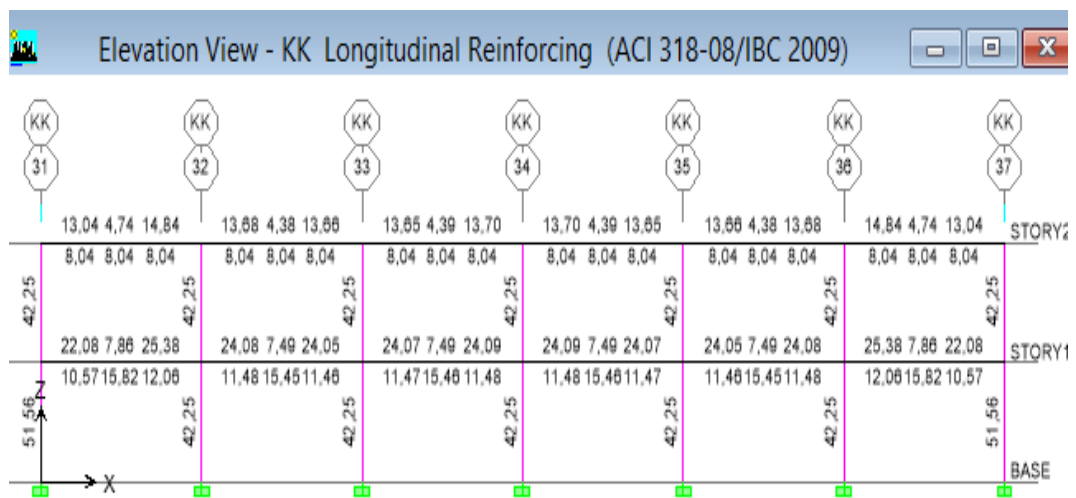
Acero en Vigas y Columnas en el Pórtico KK – C. Quirúrgico- (NEC-11)
